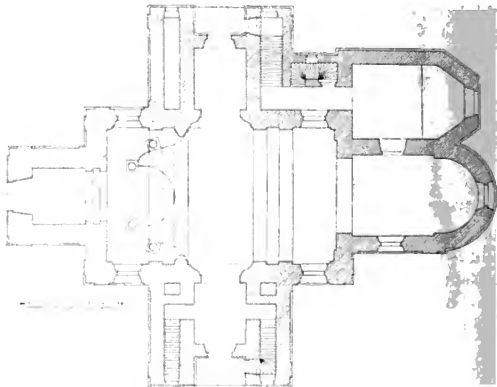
Chlumín. Grundriss der Kirche.
